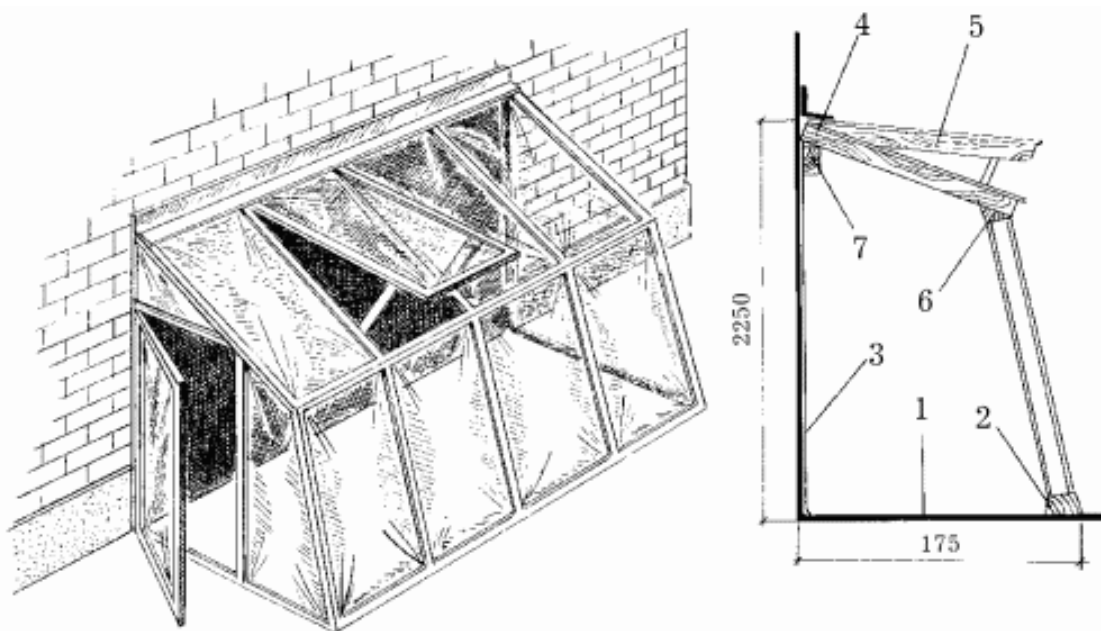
Односкатная пристенная теплица: а – общий вид, б – поперечный разрез: 1 – основание с уклоном, 2 – фундамент, 3 – гидроизоляция стены, 4 – водоотливной козырек, 5 – подъемная рама-форточка, 6 – угловой продольный брус, 7 – настенный брусок каркаса.
